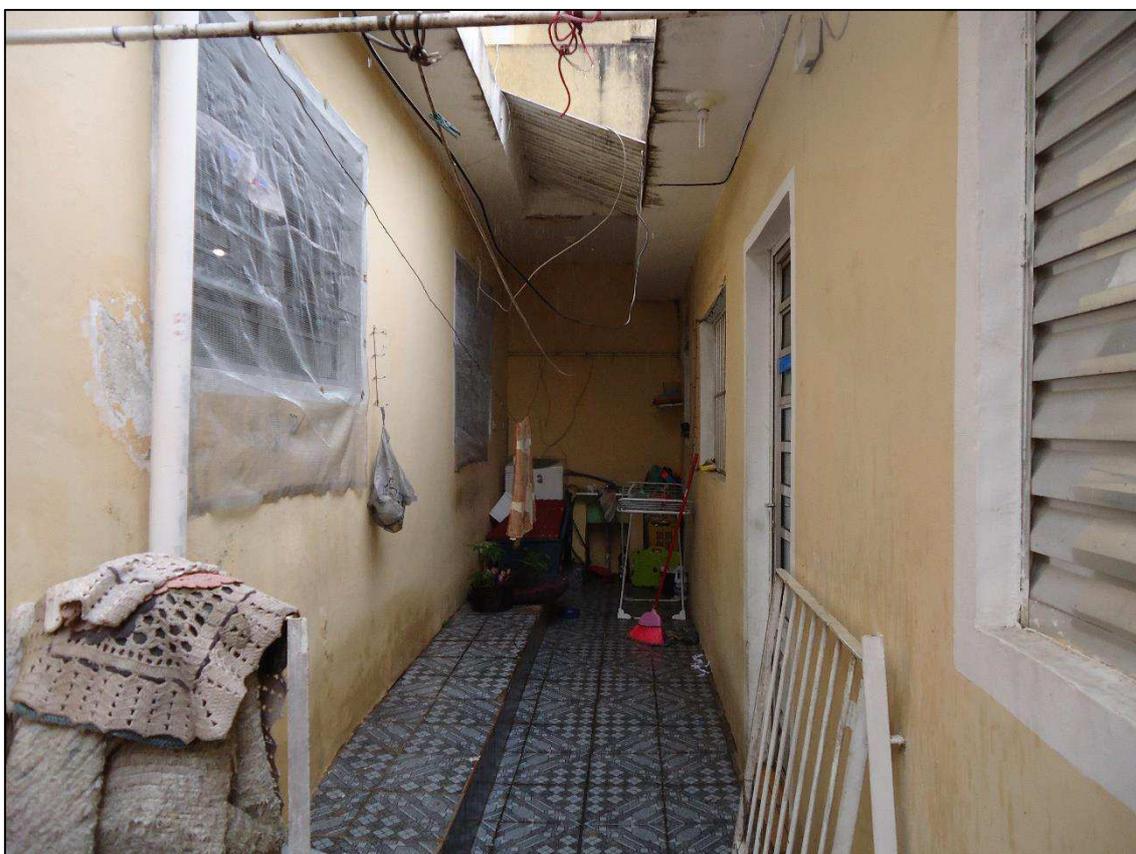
Vista do acesso para as construções secundárias (1) lado esquerdo e (2) no lado direito.
